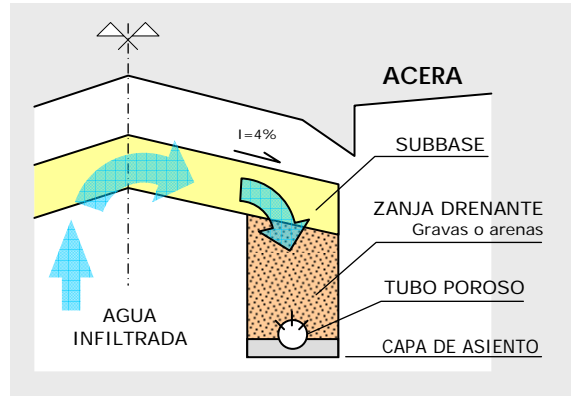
Conexión entre la capa subbase y el drenaje profundo
